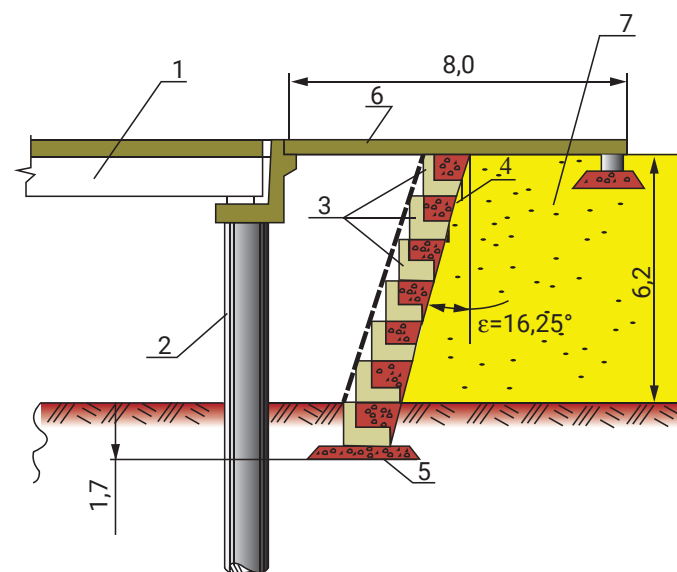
Схема автодорожного моста с устоями в виде подпорных стен из пустотелых железобетонных блоков, заполненных щебнем: 1 — пролетное строение; 2 — безростверковые опоры из буровых свай; 3 — пустотелые железобетонные блоки; 4 — щебень; 5 — матрац Рено; 6 — переходная плита; 7 — подходная насыпь
